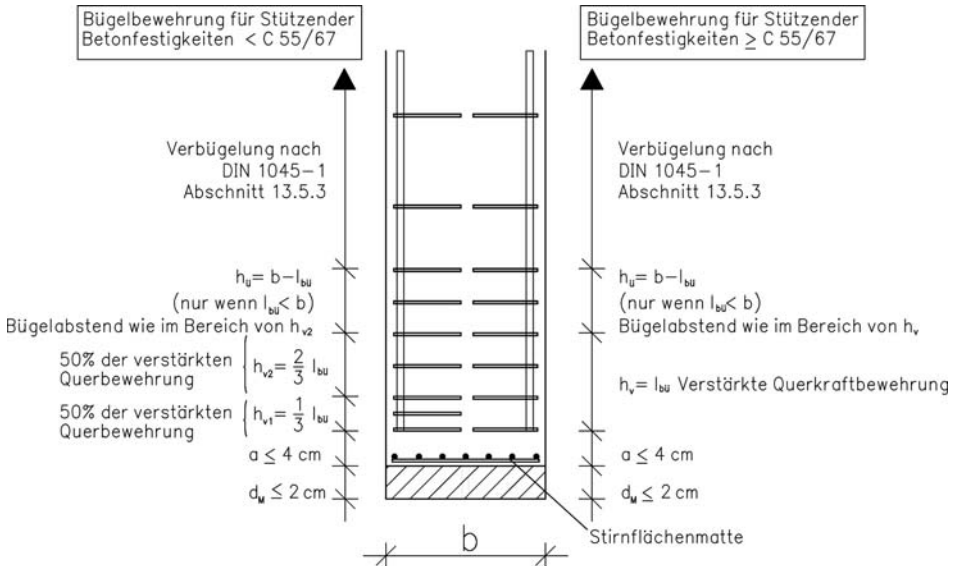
Konstruktive Durchbildung des Stoßbereiches [212]
